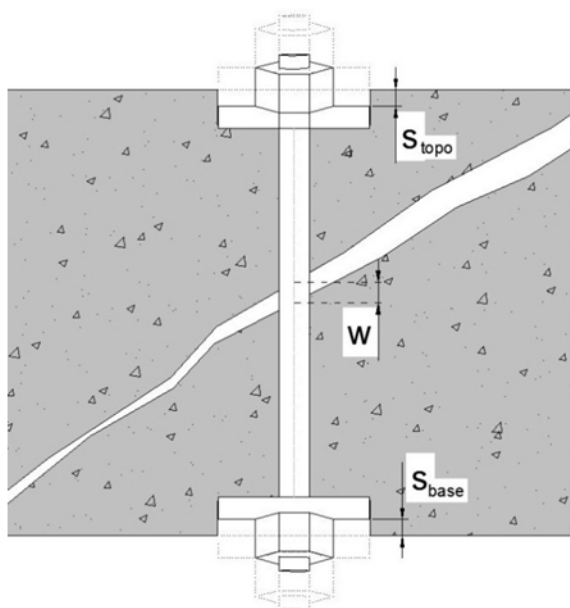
Pormenorização da intersecção da abertura de fenda com a ancoragem
